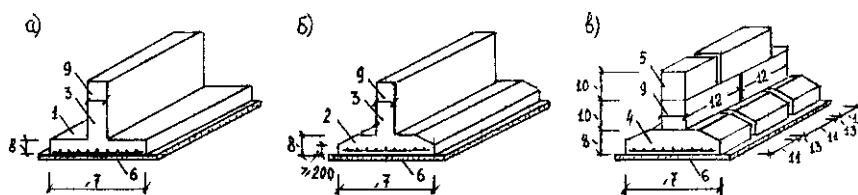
Конструктивные элементы ленточного фундамента под несущие стены: а – монолитного с лентой прямоугольного сечения, б – монолитного с лентой трапецеидального сечения, в – сборного с блок-подушкой трапецеидального сечения
